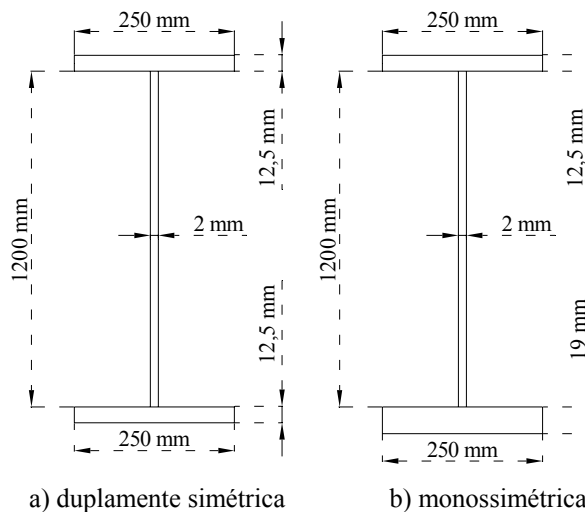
Dimensões das vigas com altura de alma de 1200 mm
